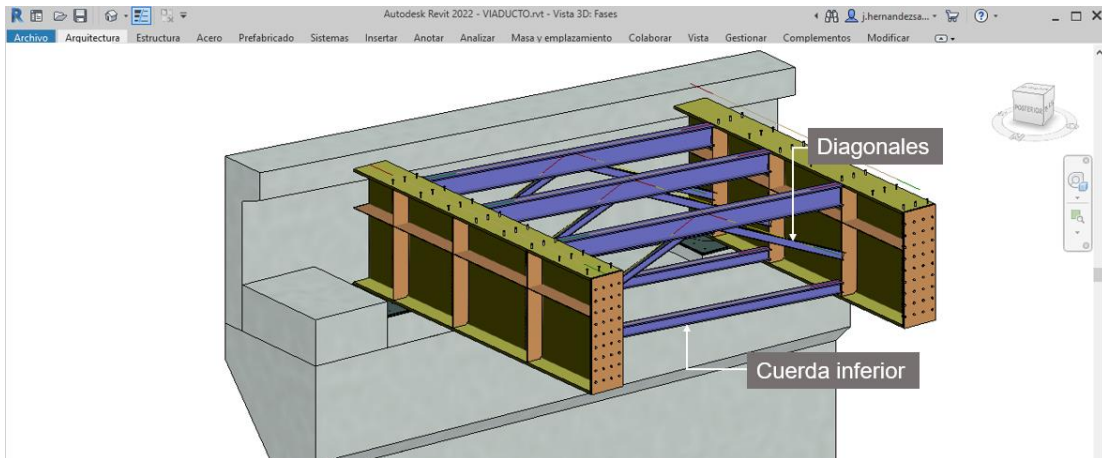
Creación de complementos de las traves. Fuente: Elaboración propia
